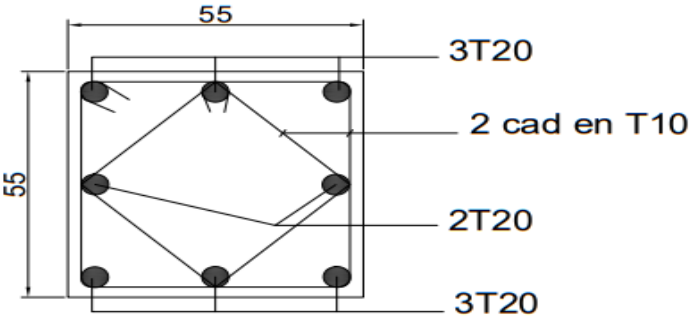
Schéma de ferrailage des poteaux de la 'ZONE 1'
